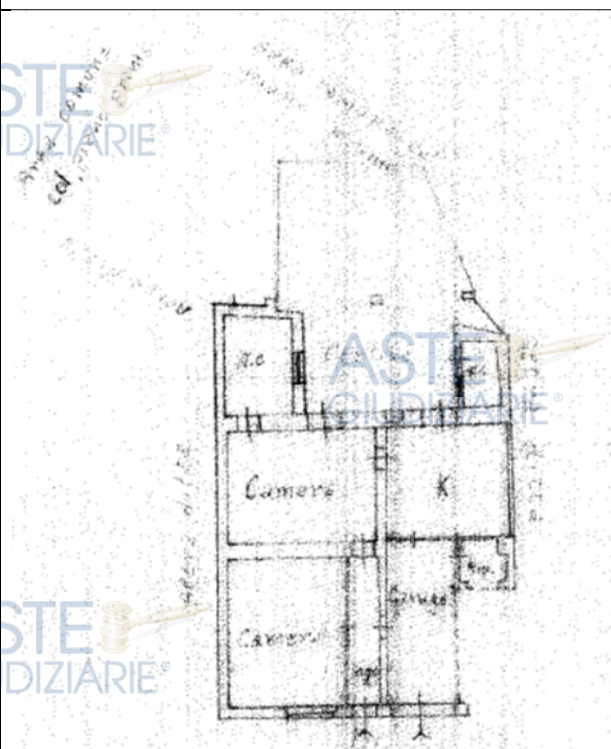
Planimetria catastale foglio 26 part. 90 sub2
